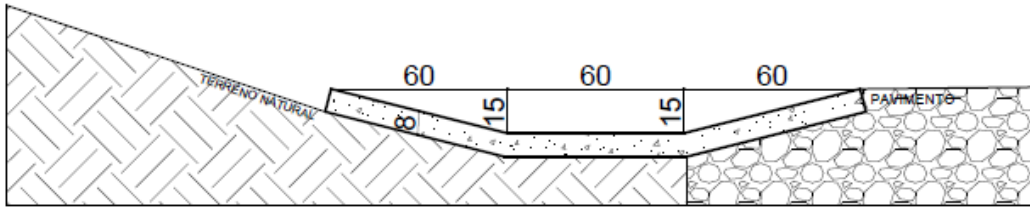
Sarjeta Trapezoidal de Concreto Revisada 02 (SZC 02-2r)
